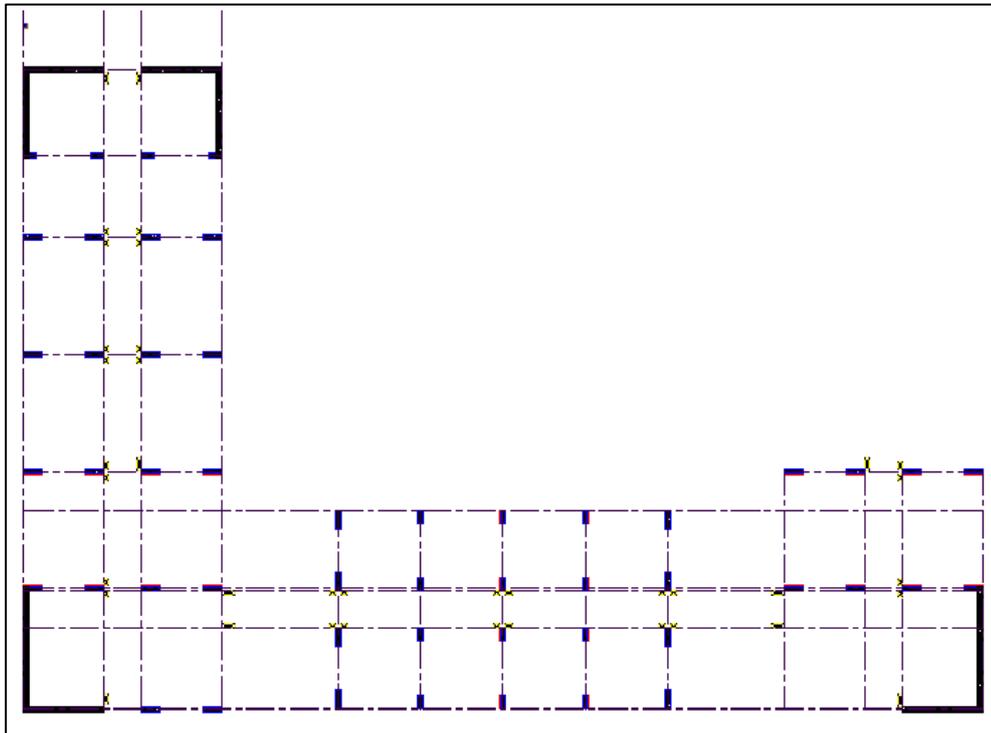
Denah Kolom dan Dinding Geser Eksisting Lantai 14 Sampai Lantai Atap Tipe B
